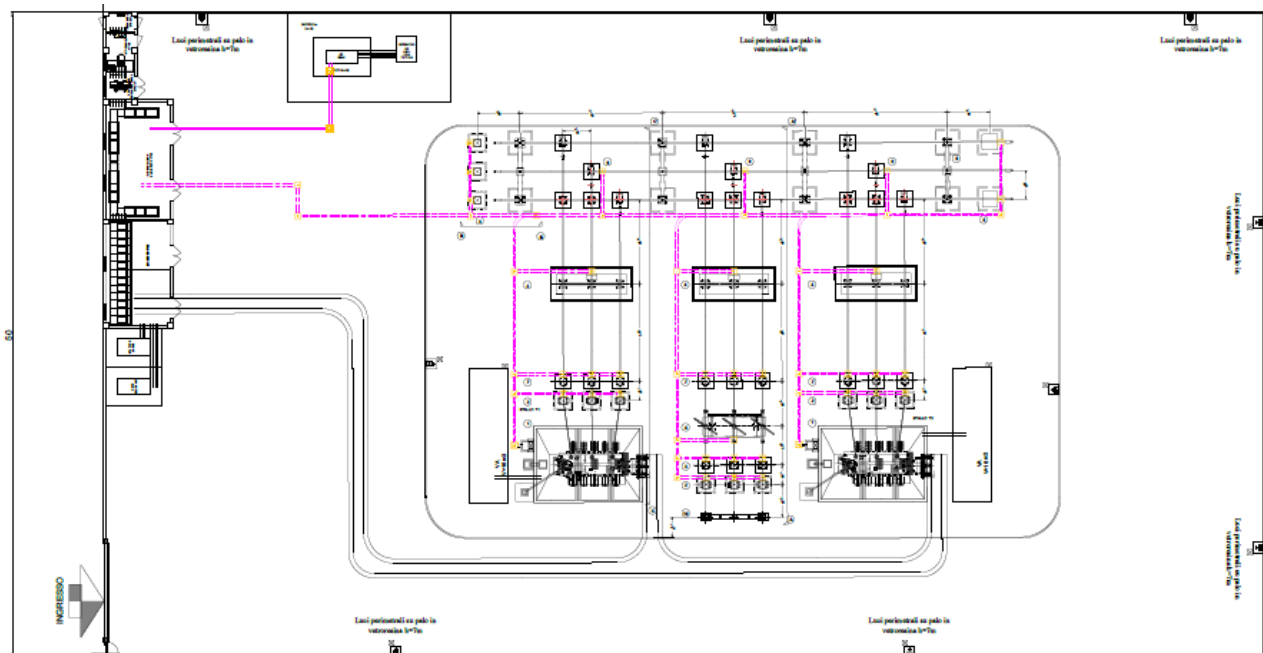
Layout futura Sottostazione Elettrica Utente
